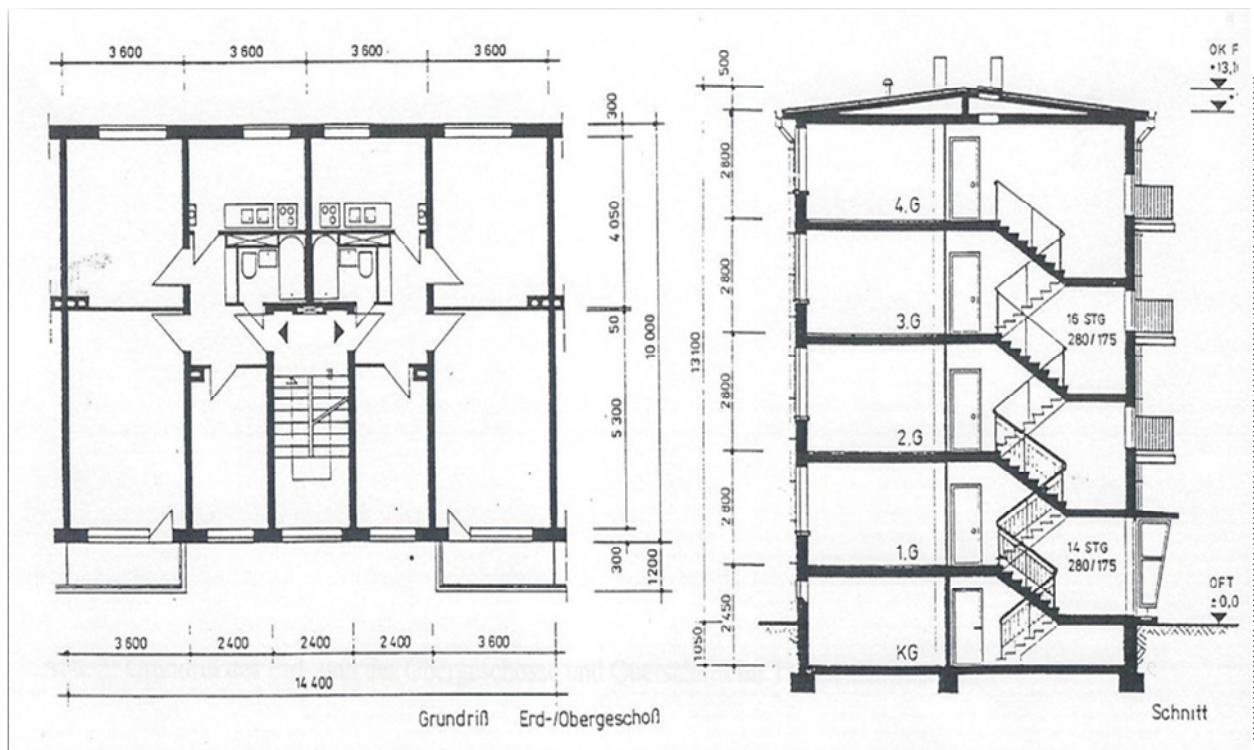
Grundriss des Erd- und der Obergeschoße und Querschnitt im Treppenhausbereich
